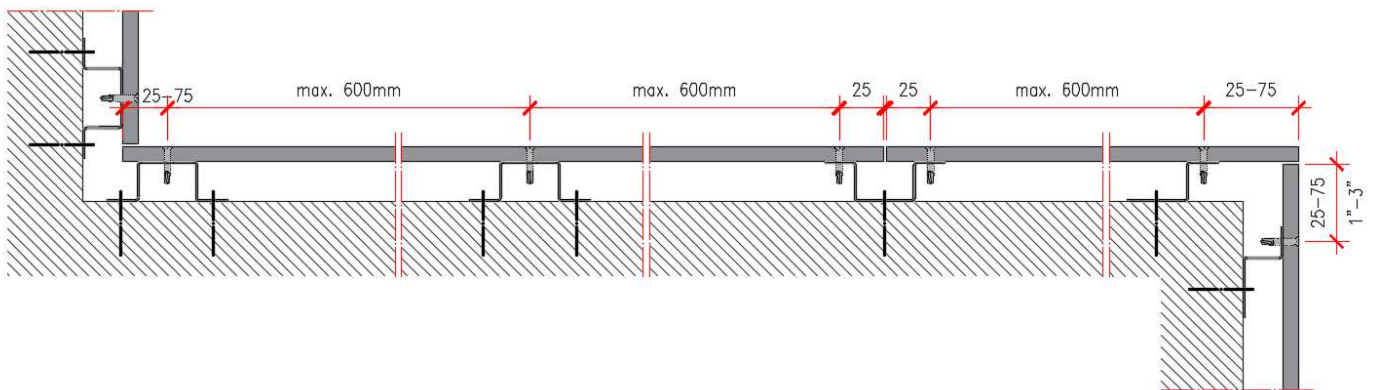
Secção horizontal, estrutura de aço galvanizado
